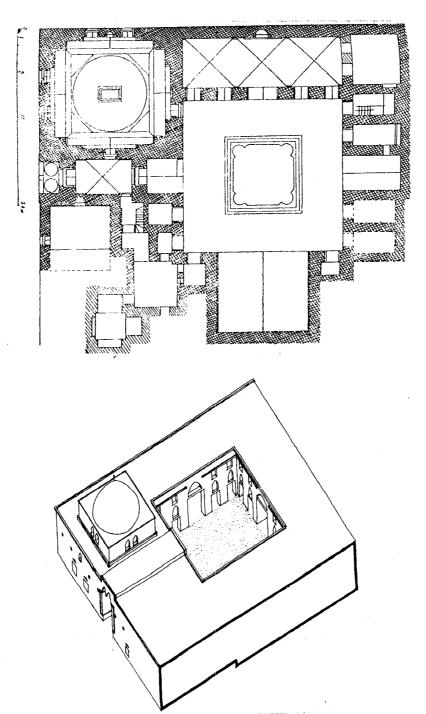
مسقط أفقي لمدرسة الفردوس في حلب (عن : كريزول) .
